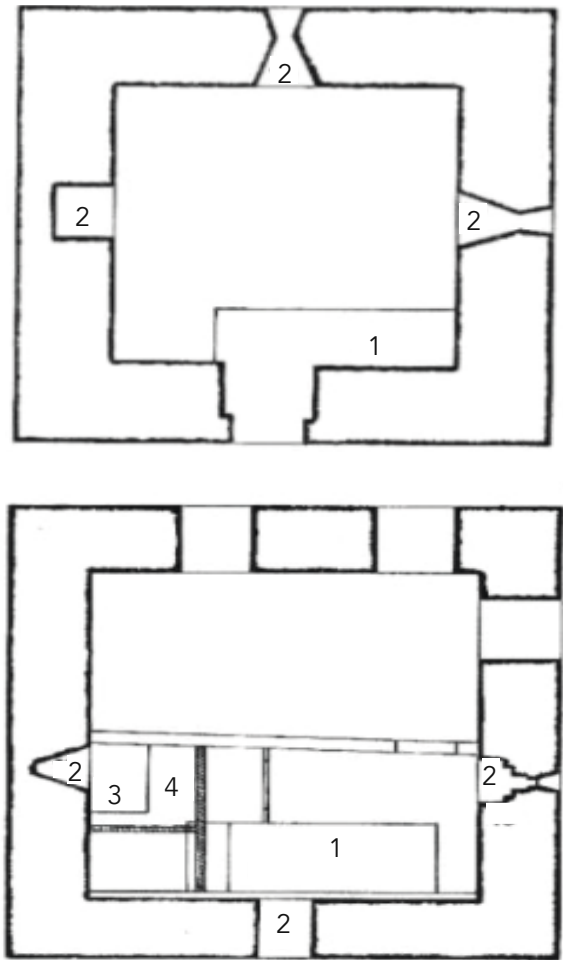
Grundrisse des oberen Torturmes, H.W. Kress, 1982
